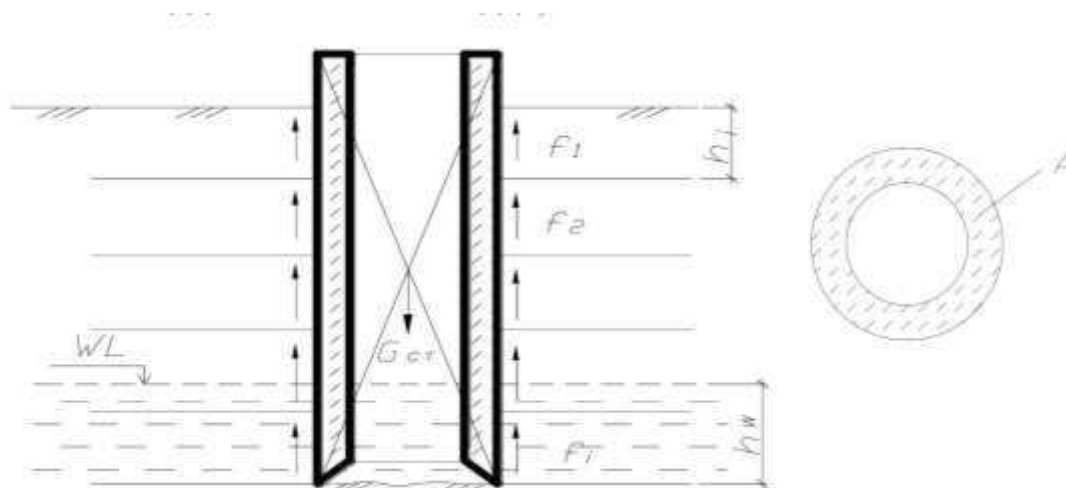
Схема к расчету опускного колодца на погружение
